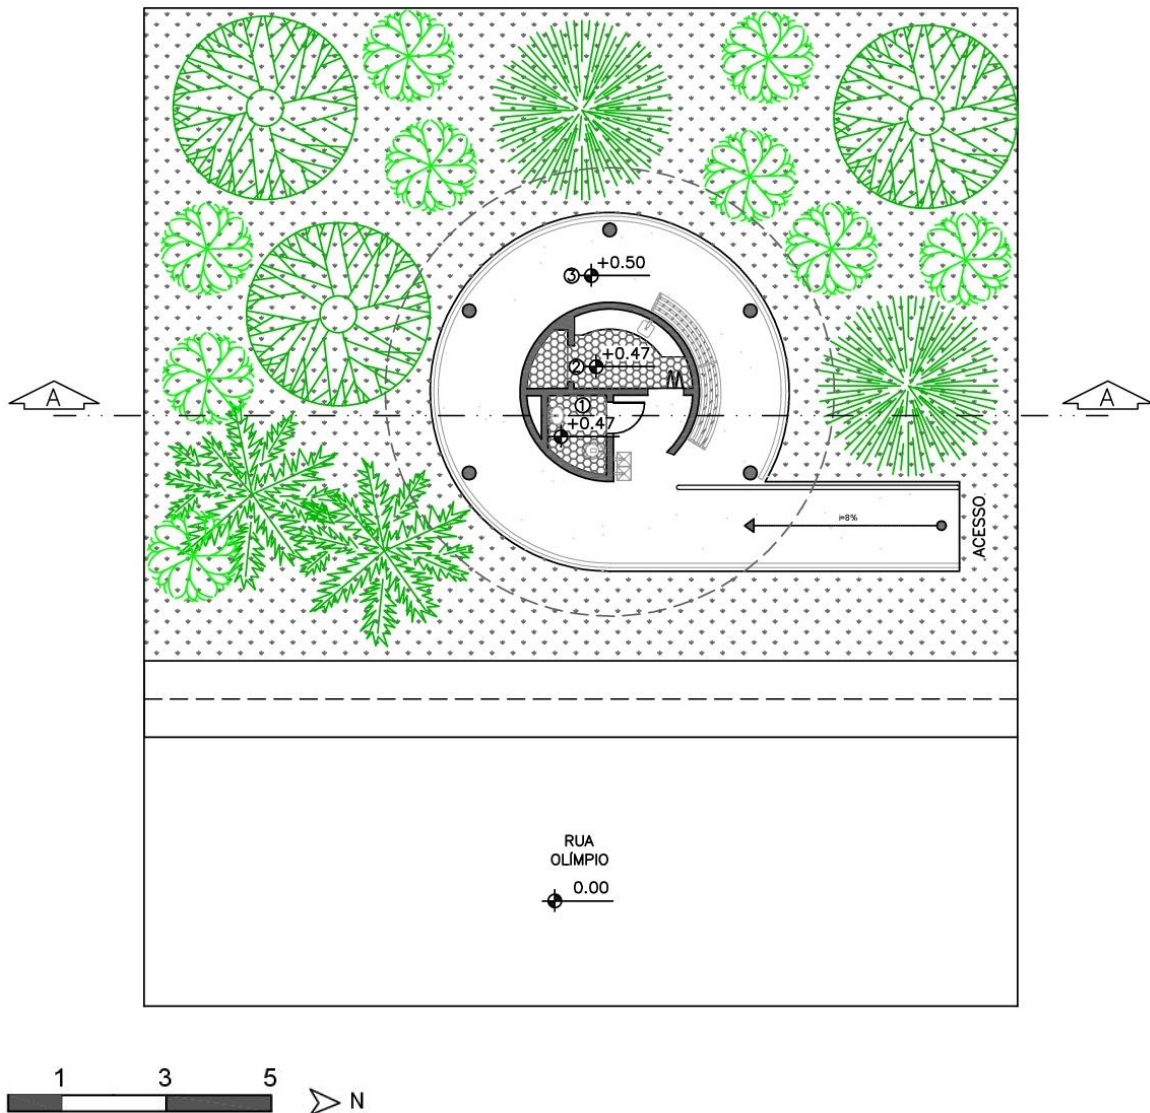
Planta Baixa Centro de Apoio - Por Eloísa Bussi Fernandes
